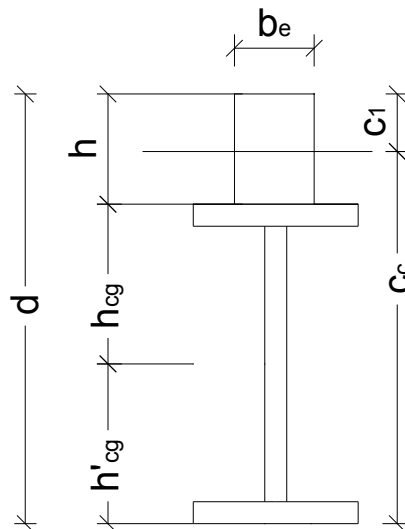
Sección compuesta homogeneizada. Losa de hormigón armado. Eje neutro en la losa.
